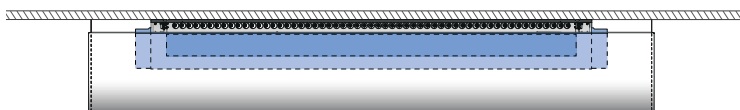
Installationsprincip "balk". Denna typ av installation kommer att behöva två designgavlar som visas på bild 55.
